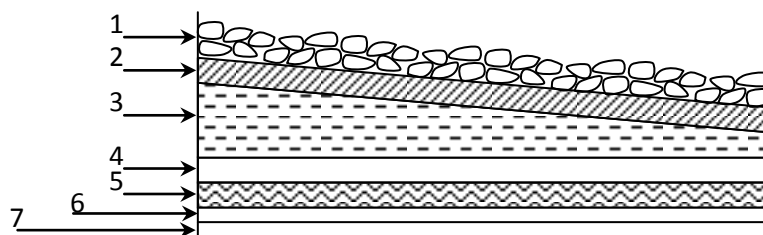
Coupe verticale d'un plancher terrasse inaccessible
